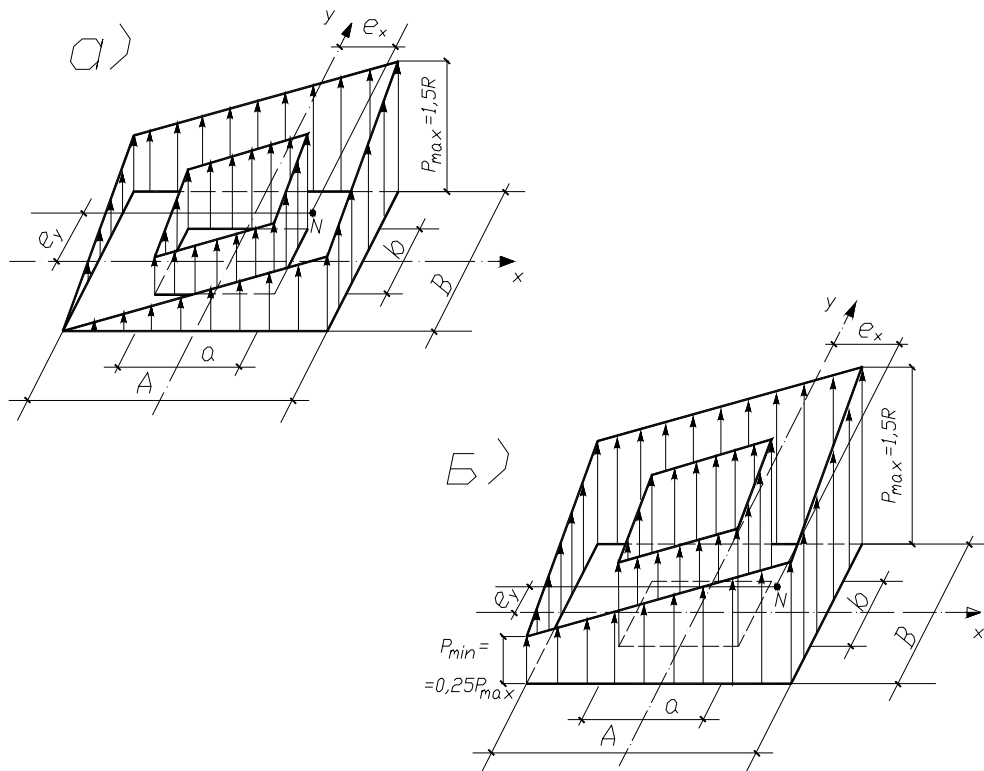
Форма фундамента с замкнутой ленточной прямоугольного очертания в плане подошвой
